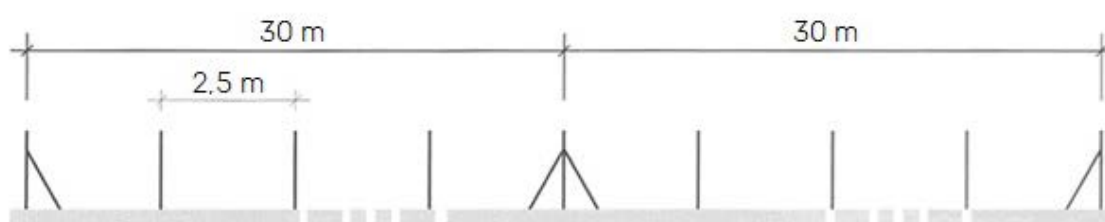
Distances entre les différents types de poteaux. 2,5 m entre les poteaux intermédiaires. 30 m entre le poteau principal d'extrémité et le poteau principal centre. 30 m entre les poteaux principaux centre.
